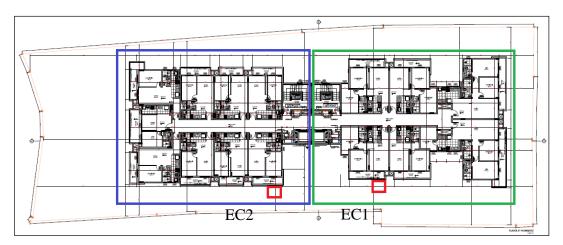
Posição dos elevadores e blocos na planta baixa tipo Fonte: Fornecido pela Construtora ABC (2016).
